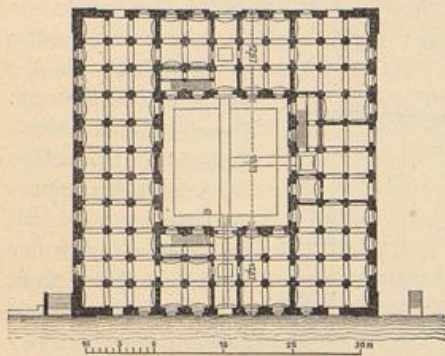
Hauptlagerhaus des Packhofes. Grundriss.
